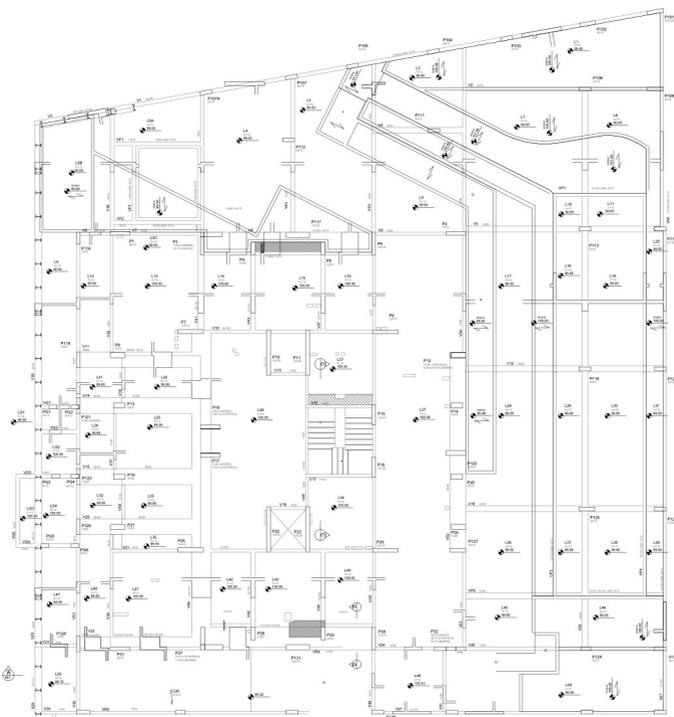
Planta de fôrma – térreo (teto 1º subsolo).
